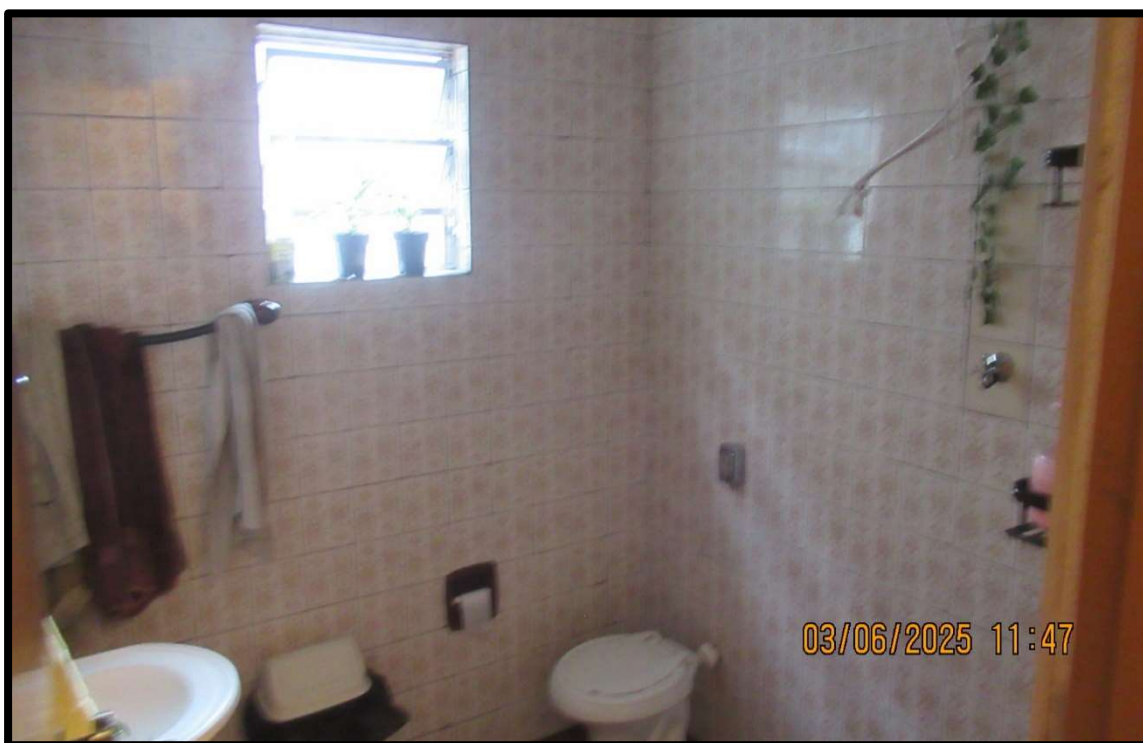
Vista de outro banheiro. Suas principais características construtivas são: piso cerâmico, paredes azulejadas até o teto, forro em laje e esquadrias de alumínio.
